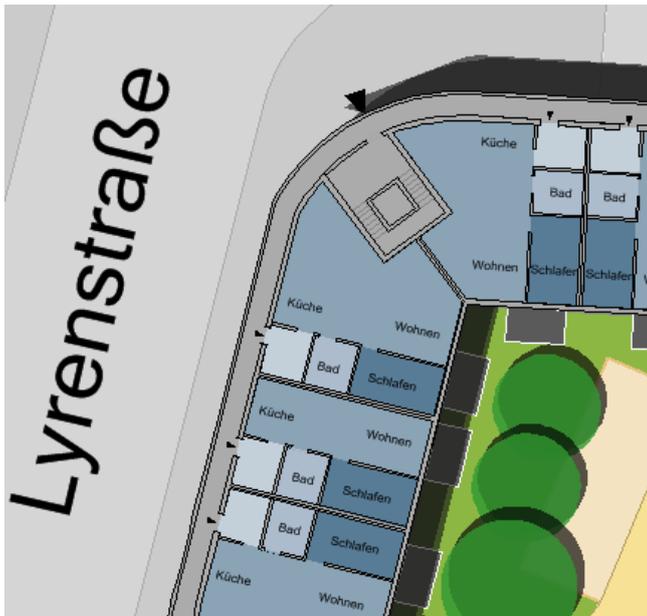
Beispielhafte Grundrissorganisation in den Obergeschossen für Wohnnutzungen, geschlossener Laubengang als „Schallschutz“ zur Lyrenstraße, Orientierung der Schlaf- und Wohnräume zum Hof
